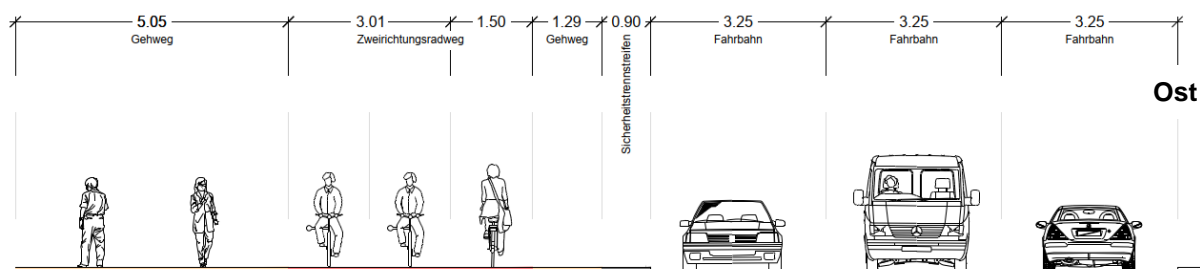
Geplanter Querschnitt Planstraße A (nördlicher Abschnitt)
